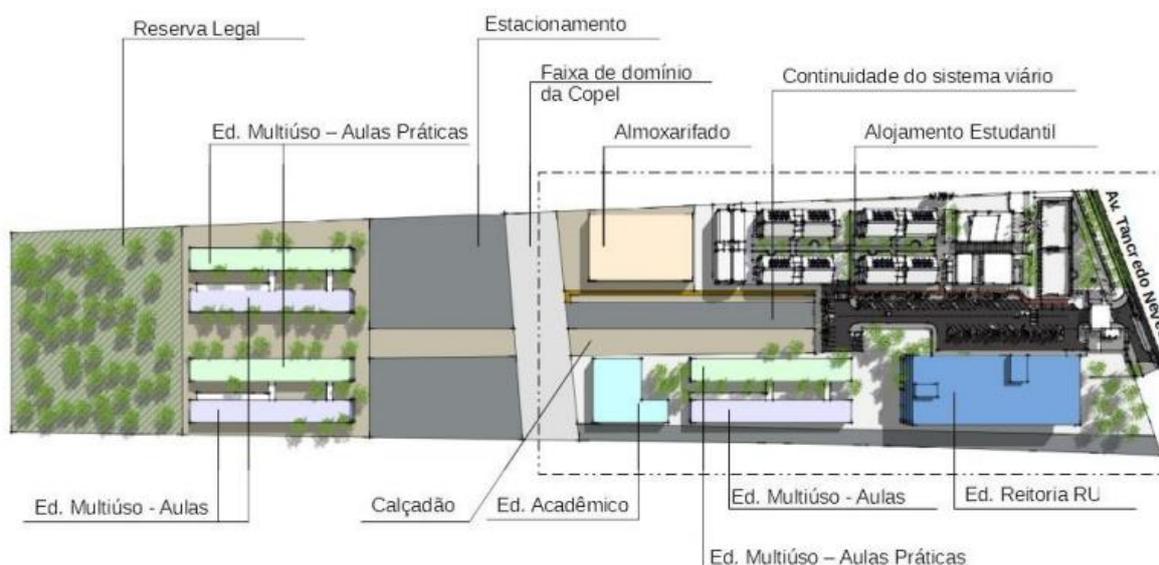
Plano de Edificações para o Campus Integração da UNILA
